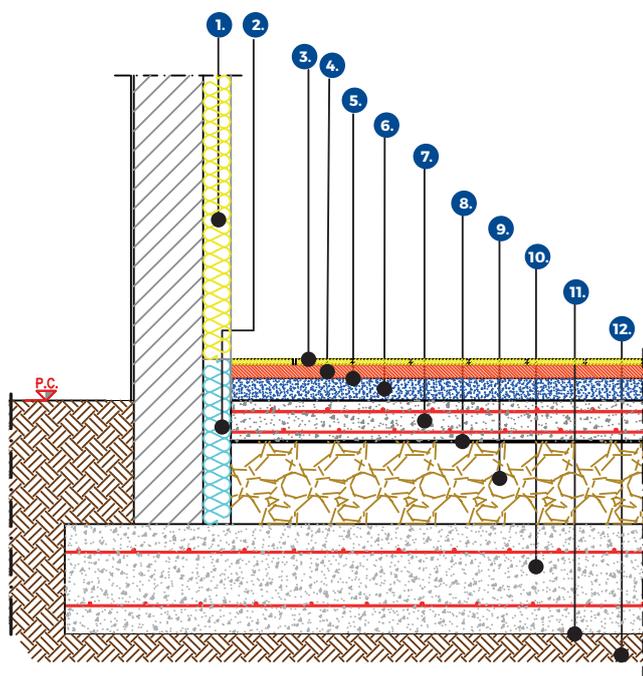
Riqualficazione solaio controterra, isolamento sopra platea di fondazione: 1) Cappotto interno, 2) Taglio termico, 3) Pavimentazione, 4) Massetto di finitura, 5) Eventuale barriera al vapore, 6) Strato di compensazione, 7) Soletta in C.A., 8) Tessuto non tessuto o barriera vapore, 9) Sottofondo isolato in argilla espansa o vetro cellulare, 10) Platea di fondazione, 11) Barriera al vapore, 12) Terreno livellato e cilindrato.
